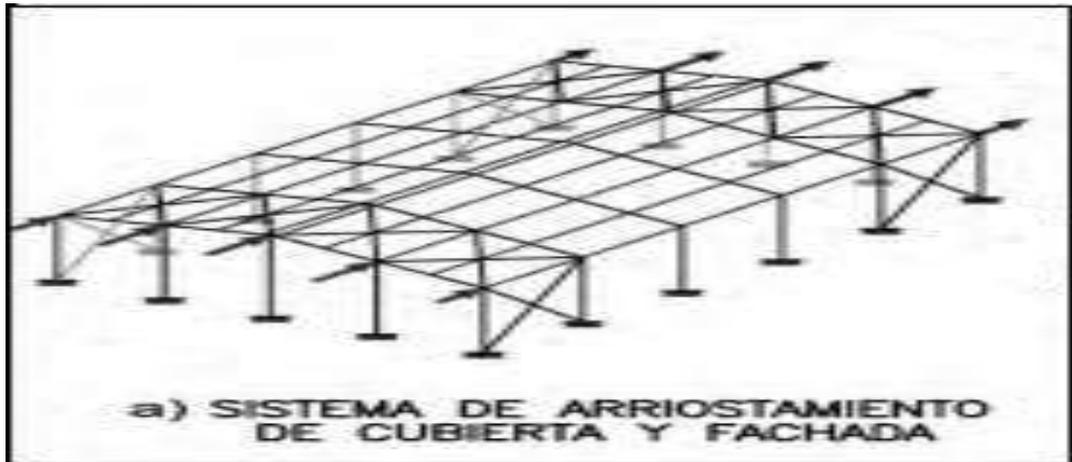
sistema de arriostamiento de cubierta y fachada
